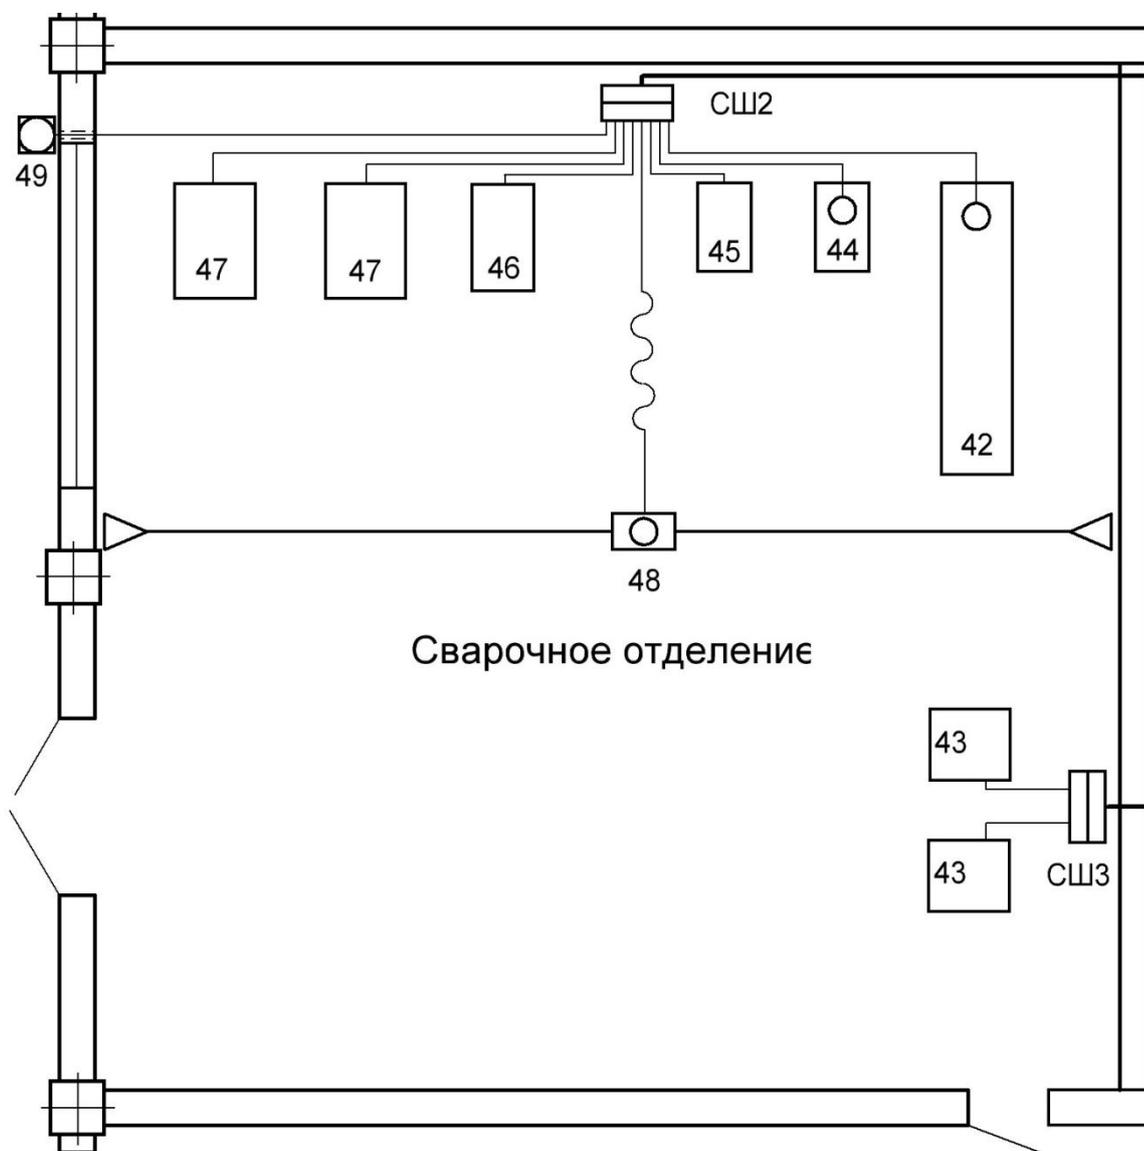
Фрагмент компоновки сварочного отделения
